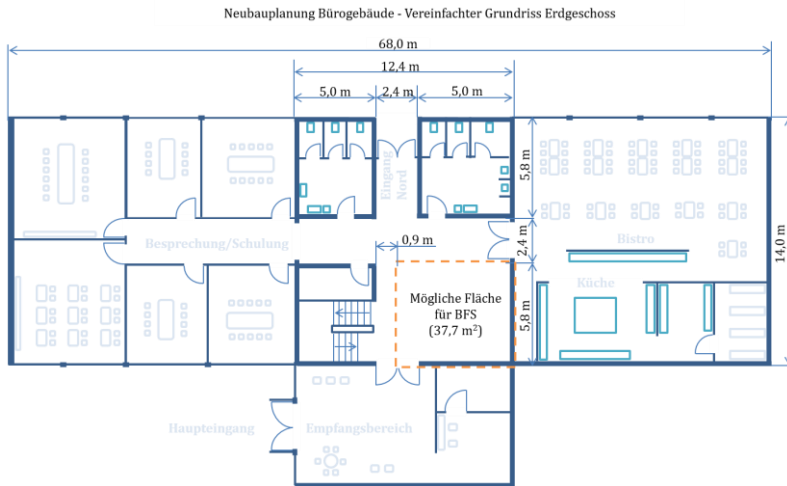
Neubauplanung Bürogebäude – Vereinfachter Grundriss Erdgeschoss (Eigene Darstellung)
